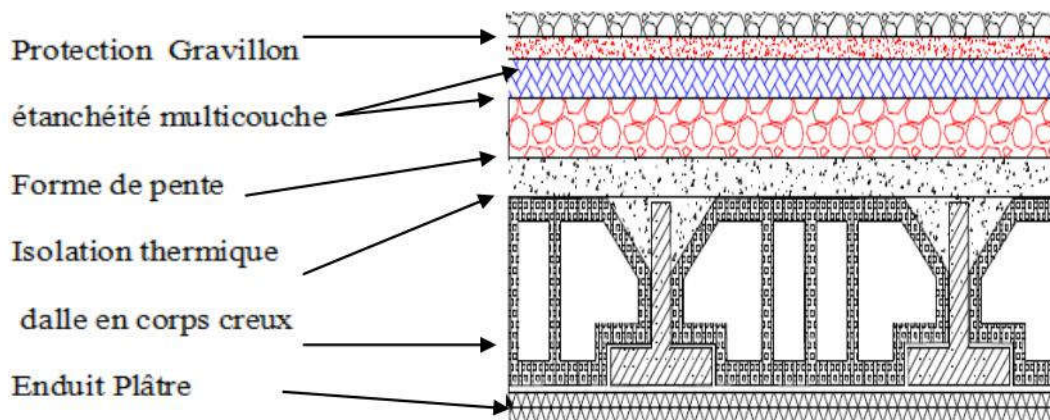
Schéma d'un plancher de terrasse inaccessible.
